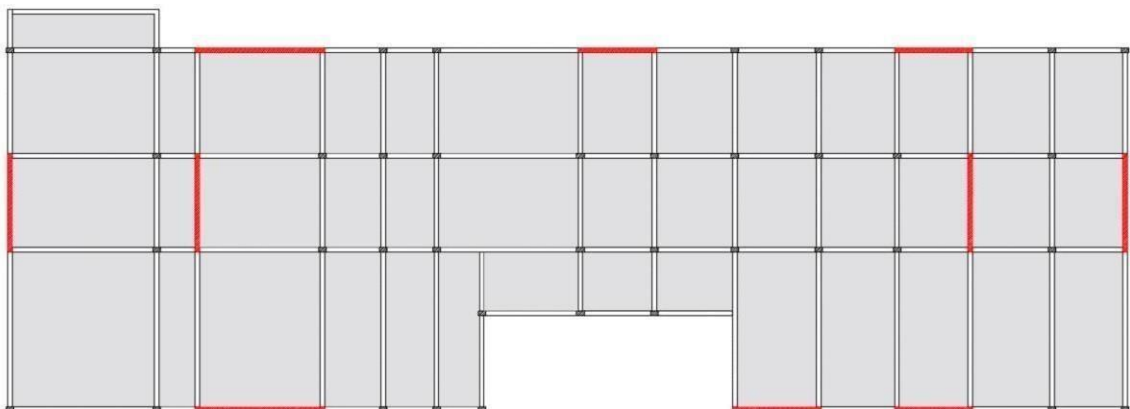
VP (25x60) - vista en planta – 1° nivel.
